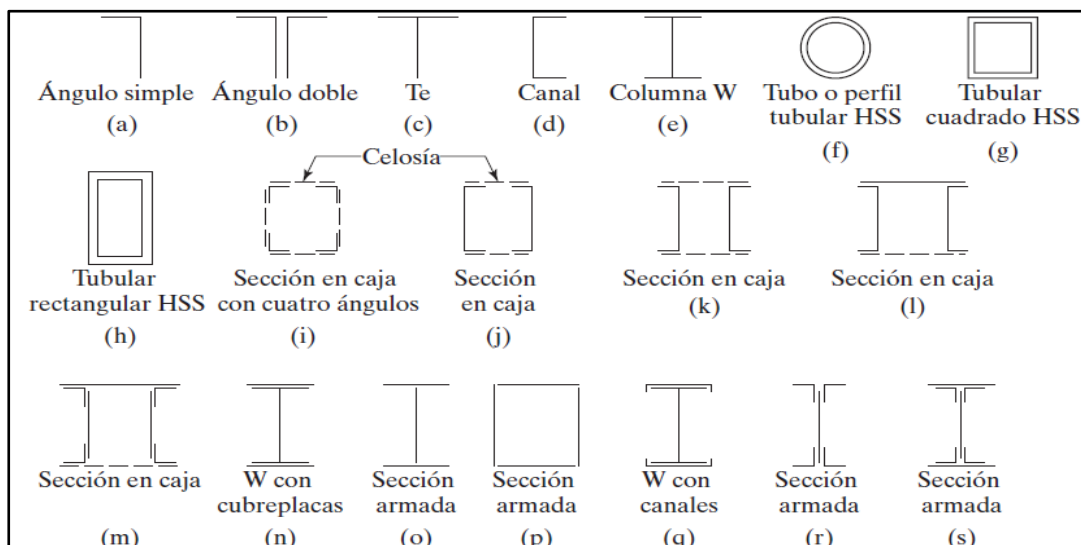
Secciones típicas de Columnas. McCormac, *Diseño de Estructuras de Acero 5ta. Edición* (2012)
